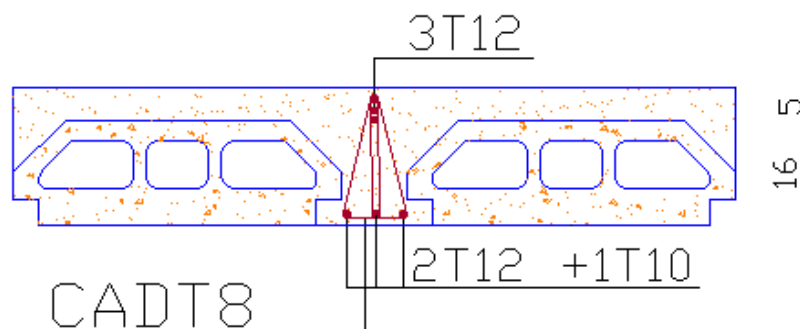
Schéma de ferrailage des poutrelles d'étage de terrasse sur appui.
